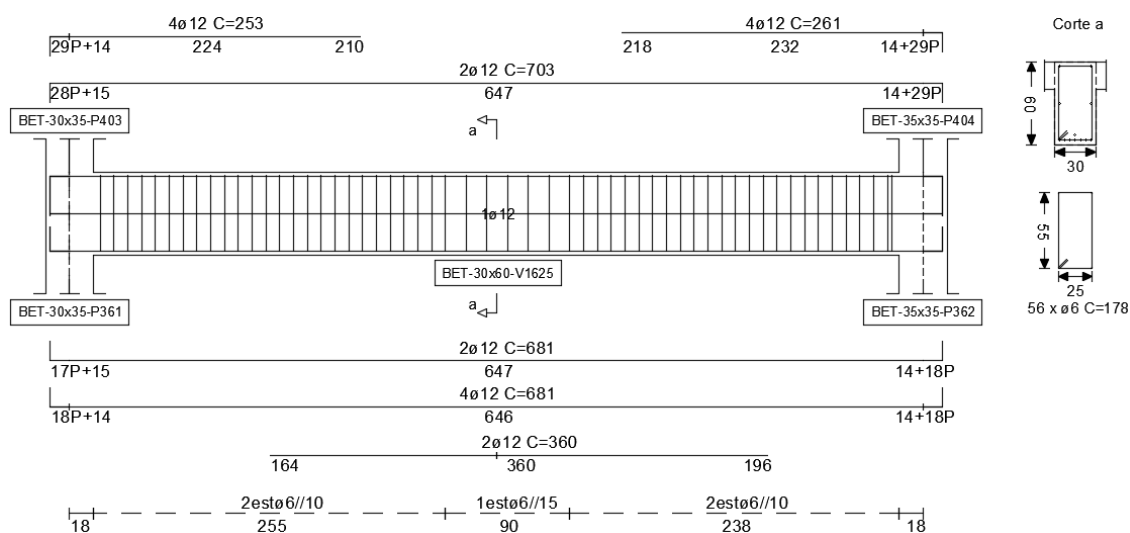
Pormenor construtivo da viga V1625 de acordo com o programa de cálculo automático
